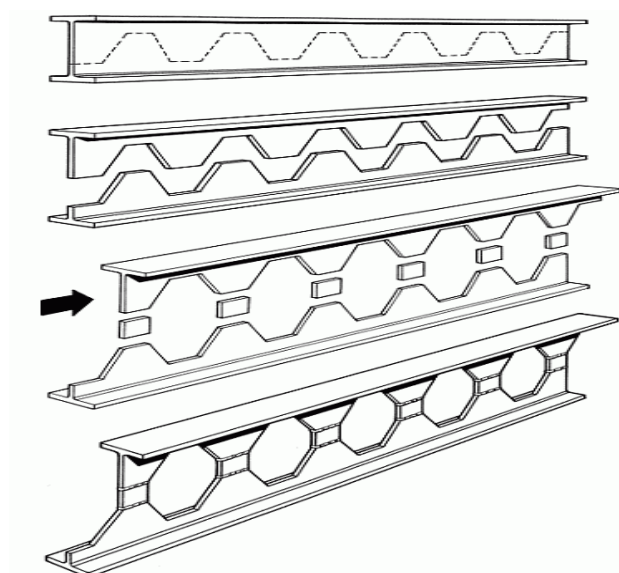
Vigas casteladas com chapas planas inseridas na semi-altura
